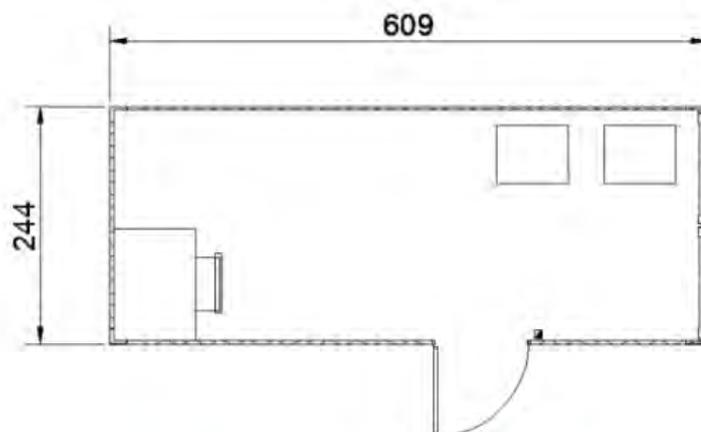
Planta de edificio de control con dimensiones (cm)
